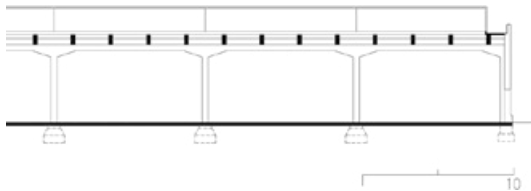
Teilquerschnitt Halle A, M 1:500 (JR, Vorlage LBK Akt-Nr. 179056).
